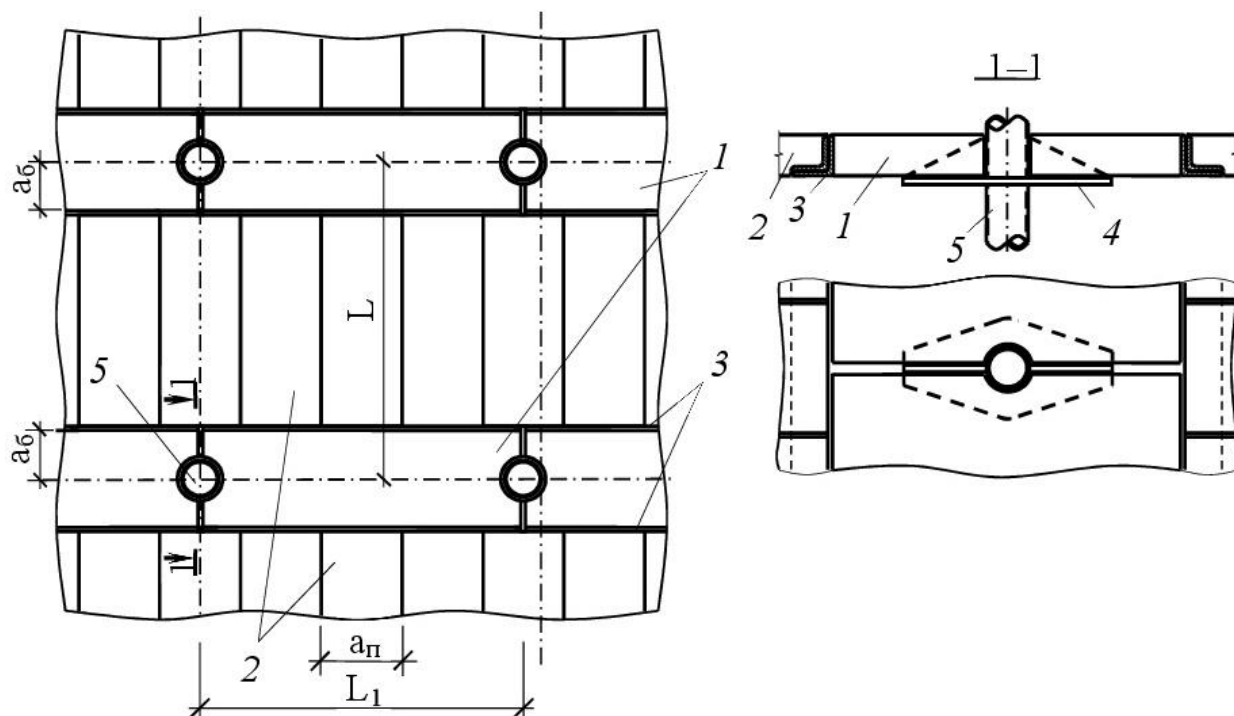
Фрагмент збірного сталезалізобетонного безбалкового перекриття:
